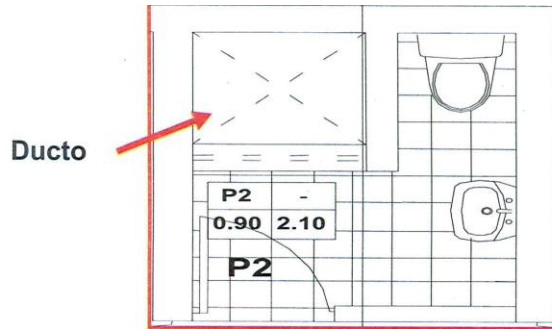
muestra donde bajar tuberías de desagüe y ventilación por el muro
